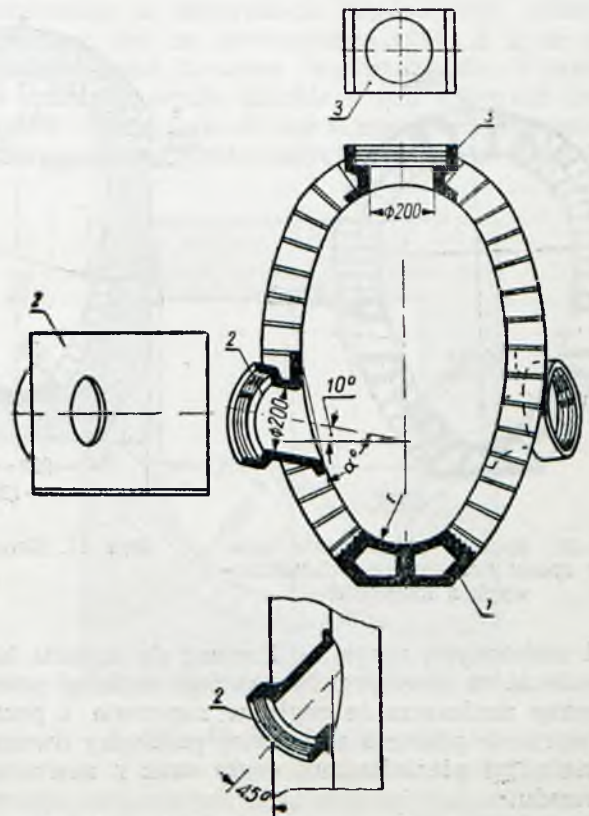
Kanał z cegły z zapłką żwirową (Stuttgart)
